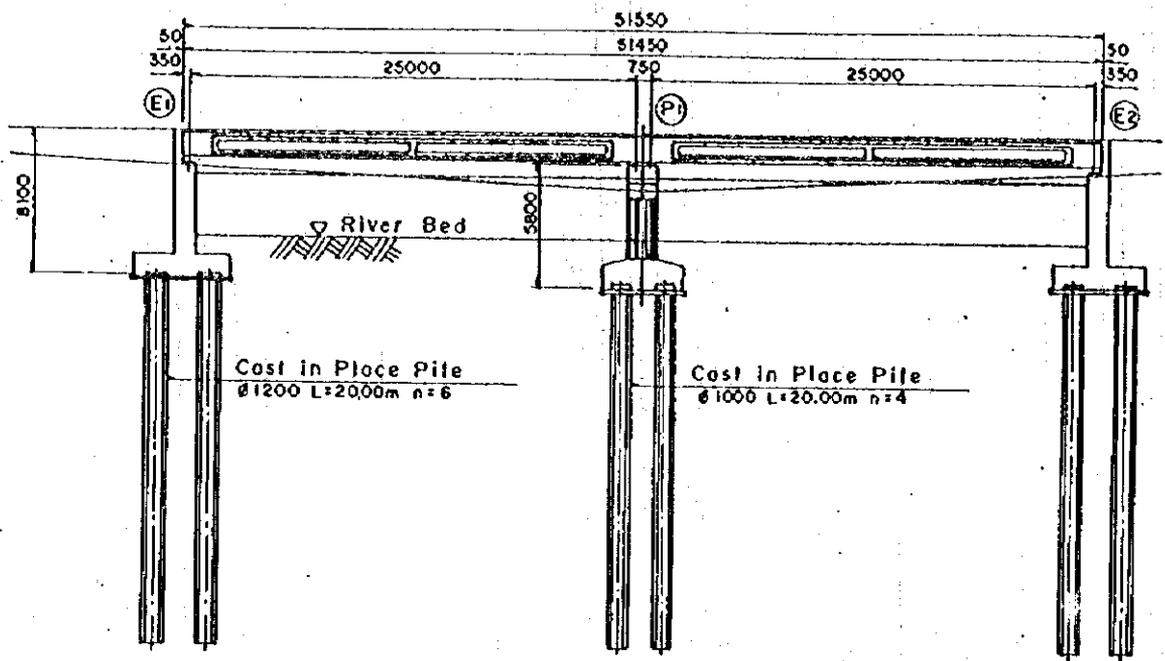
ESTRUCTURA TIPICA DE PUENTES
